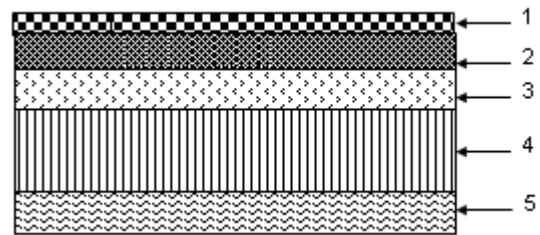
Plancher étage courant (dalle en corps creux)
